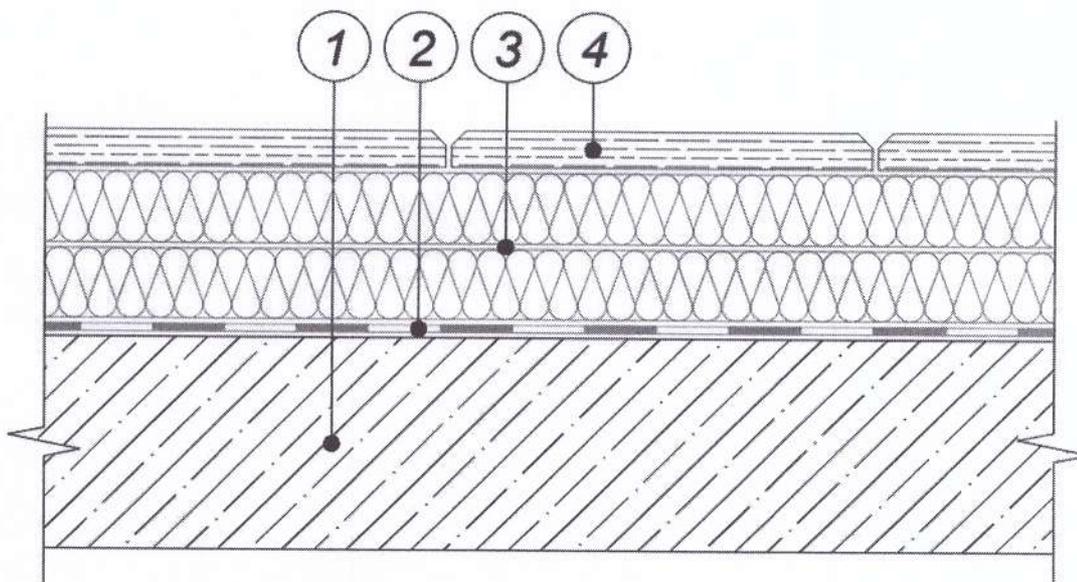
Схема конструктивного исполнения железобетонного чердачного перекрытия с системой утепления ТН-Чердак КВ (вариант 21)
